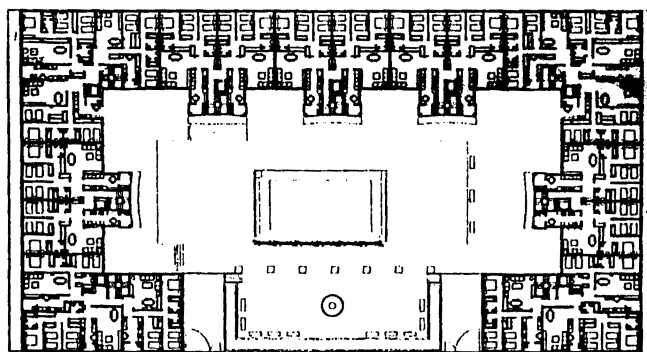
Edificación en manzana abierta en PAU II.2. Montecarmelo. Proyecto de Yleón, Arquitectura y Urbanismo, S.L.
